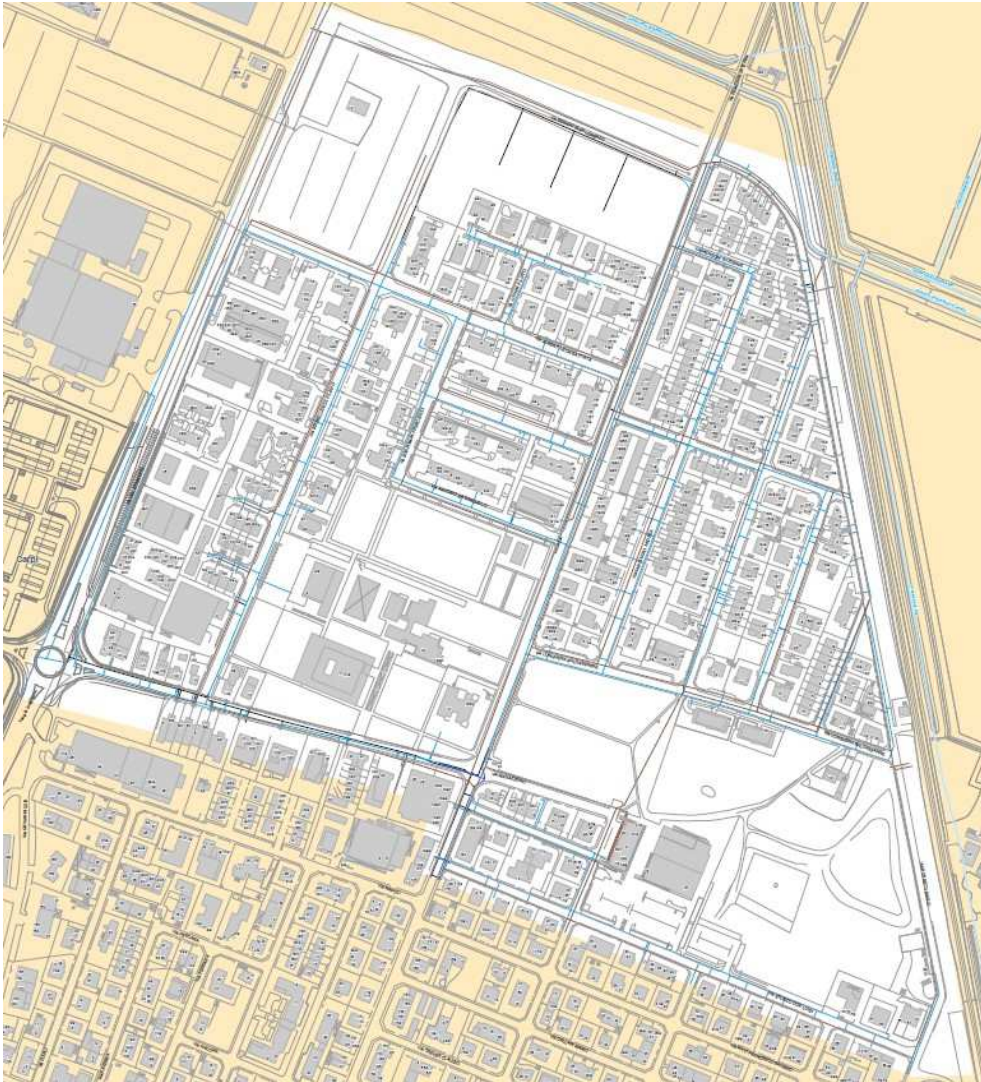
\_ Planimetria sottoservizi esistenti fornita da AIMAG\_ Rete idrica
